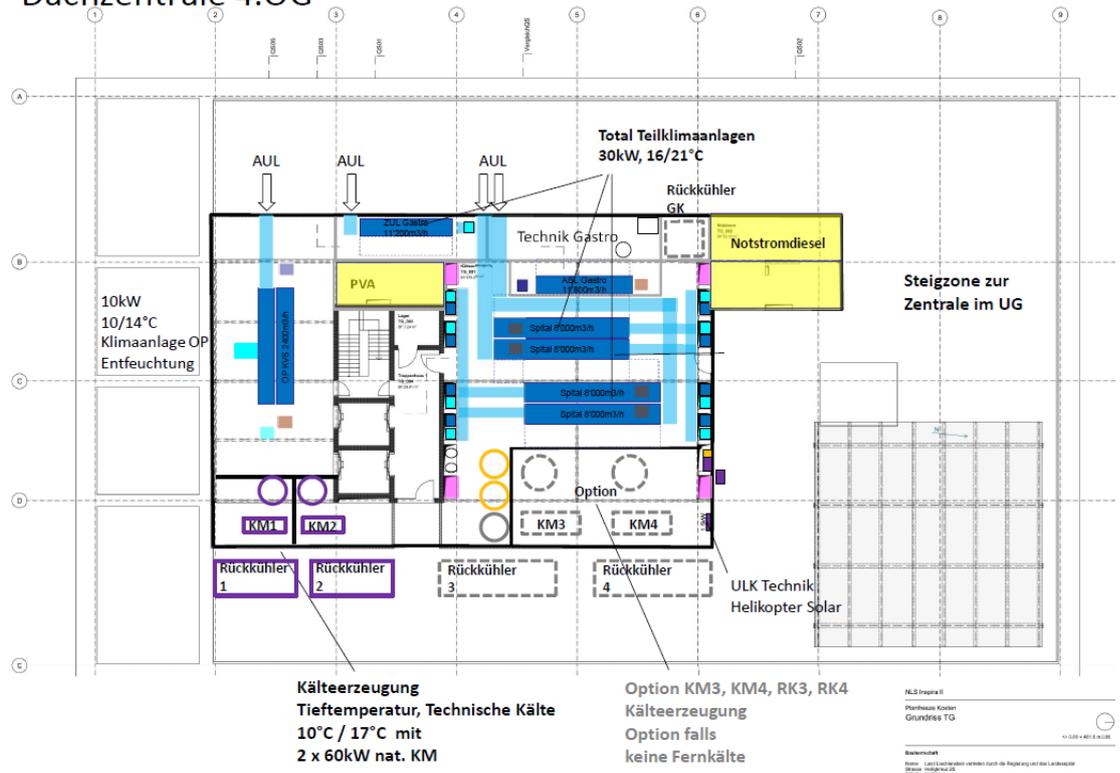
Planausschnitt Technikgeschoss, 3-Plan Haustechnik AG, Dez. 2023.
